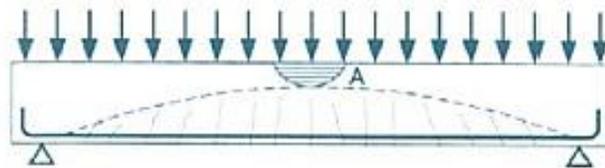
Fisuración por esfuerzo de tracción simple
